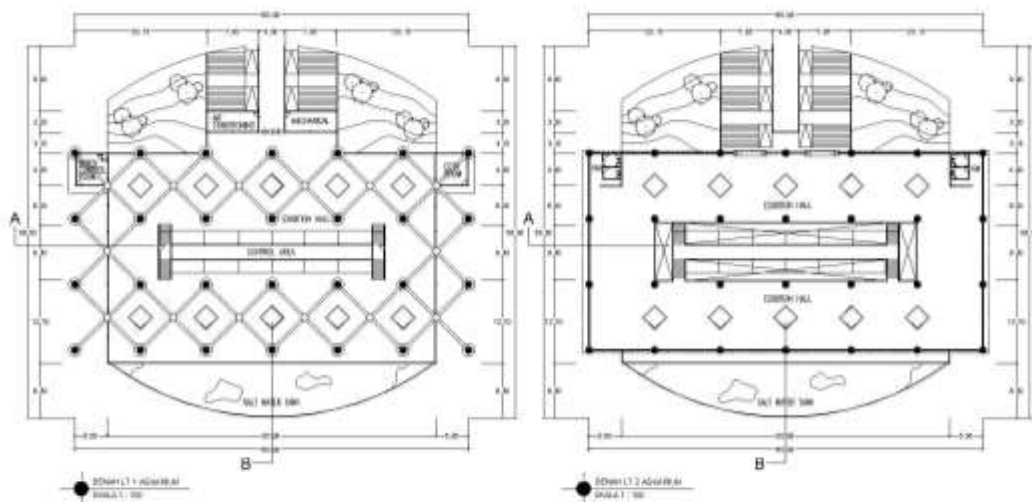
1 Denah Lantai 1 Gedung Diorama, Perpustakaan dan Kantor
